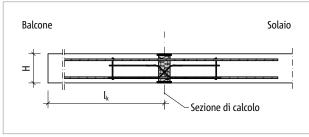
Schöck Isokorb® T tipo DL: sistema statico
